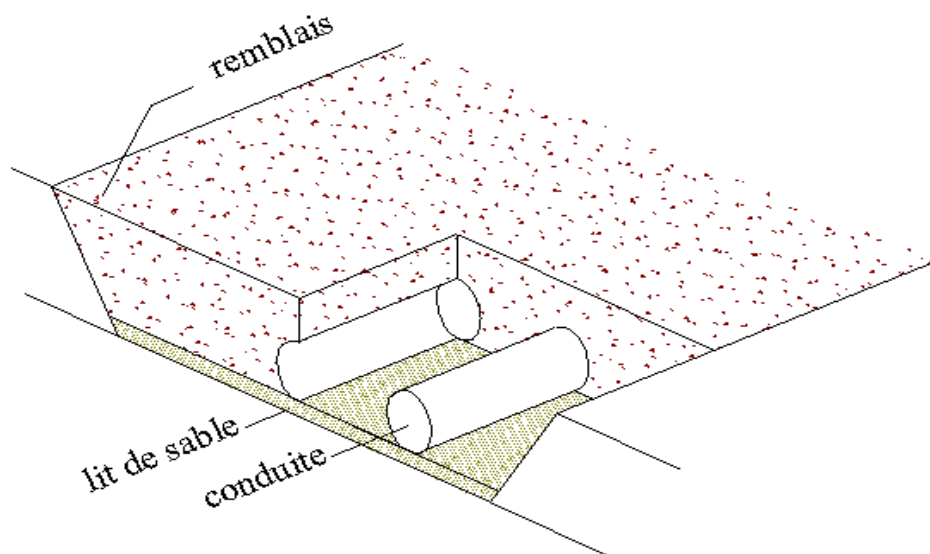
Coupe transversale d'une tranchée avec la mise en place de la conduite
